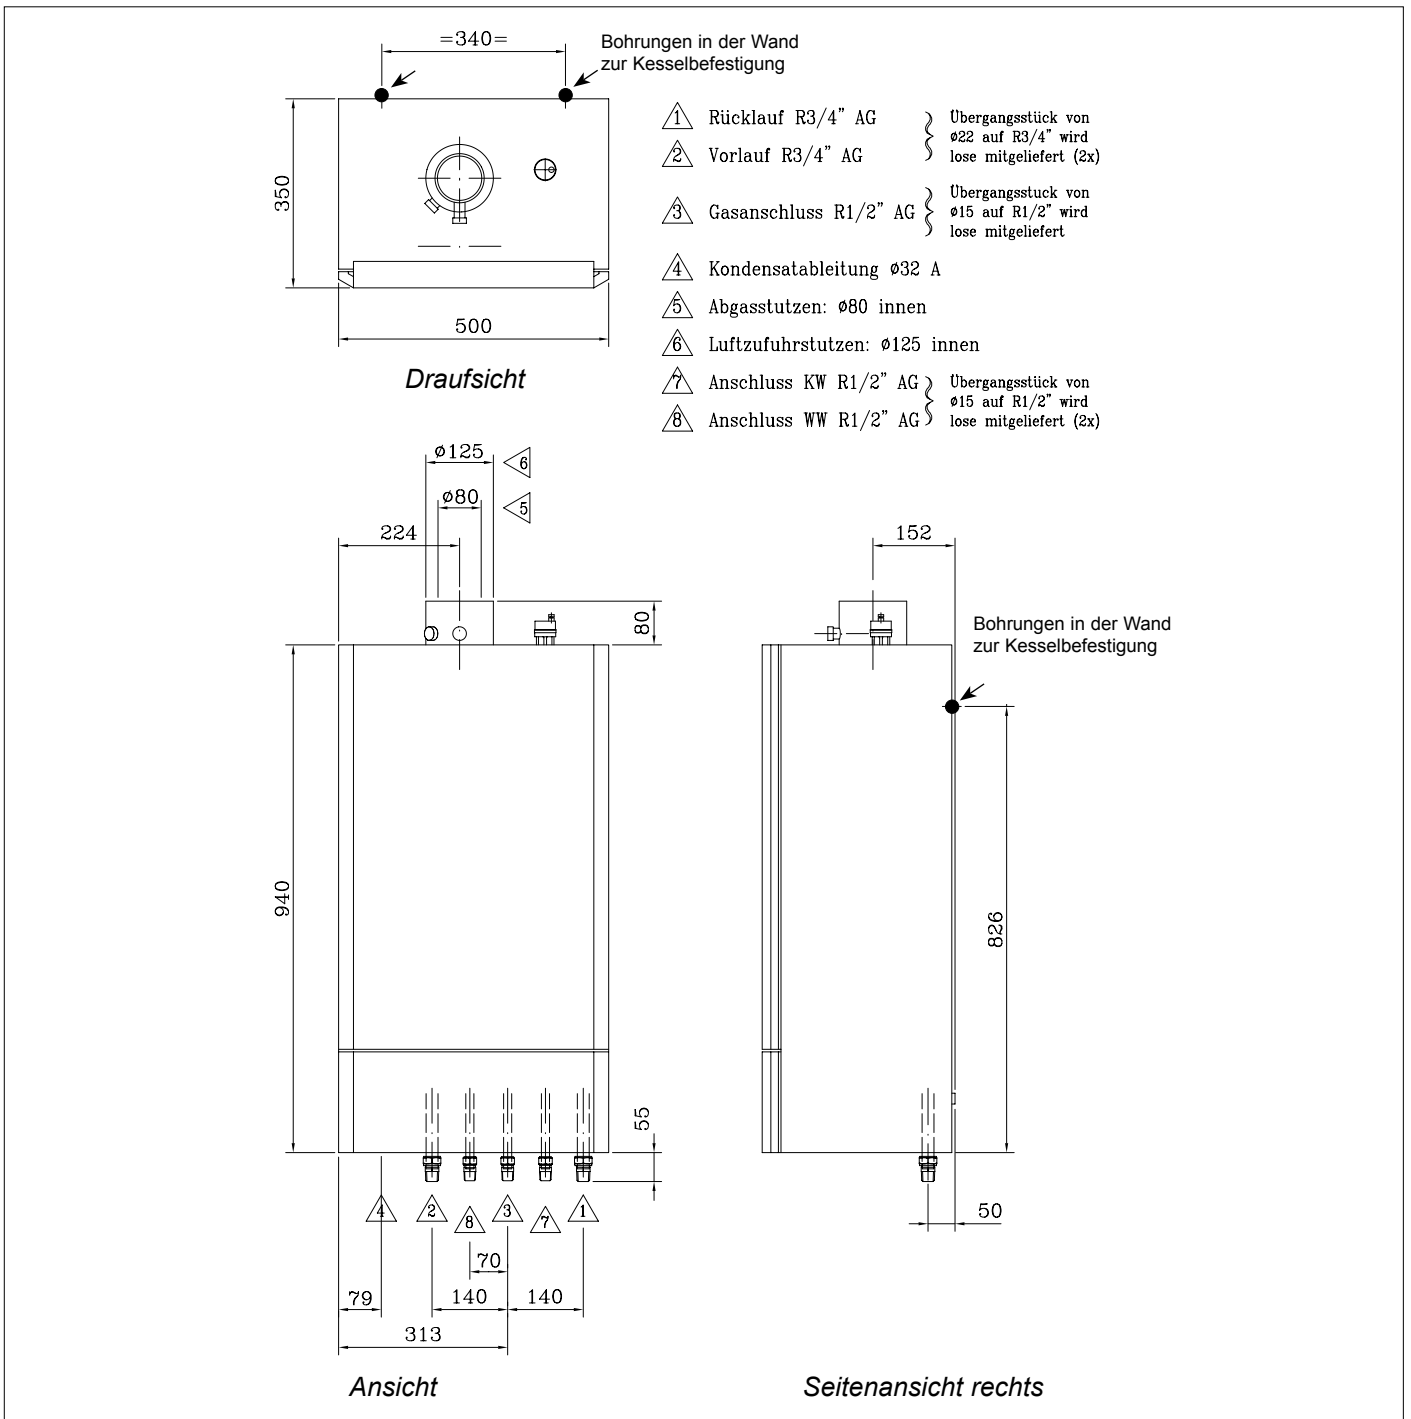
Abmessungen Remeha W21/28 ECO-Combi
